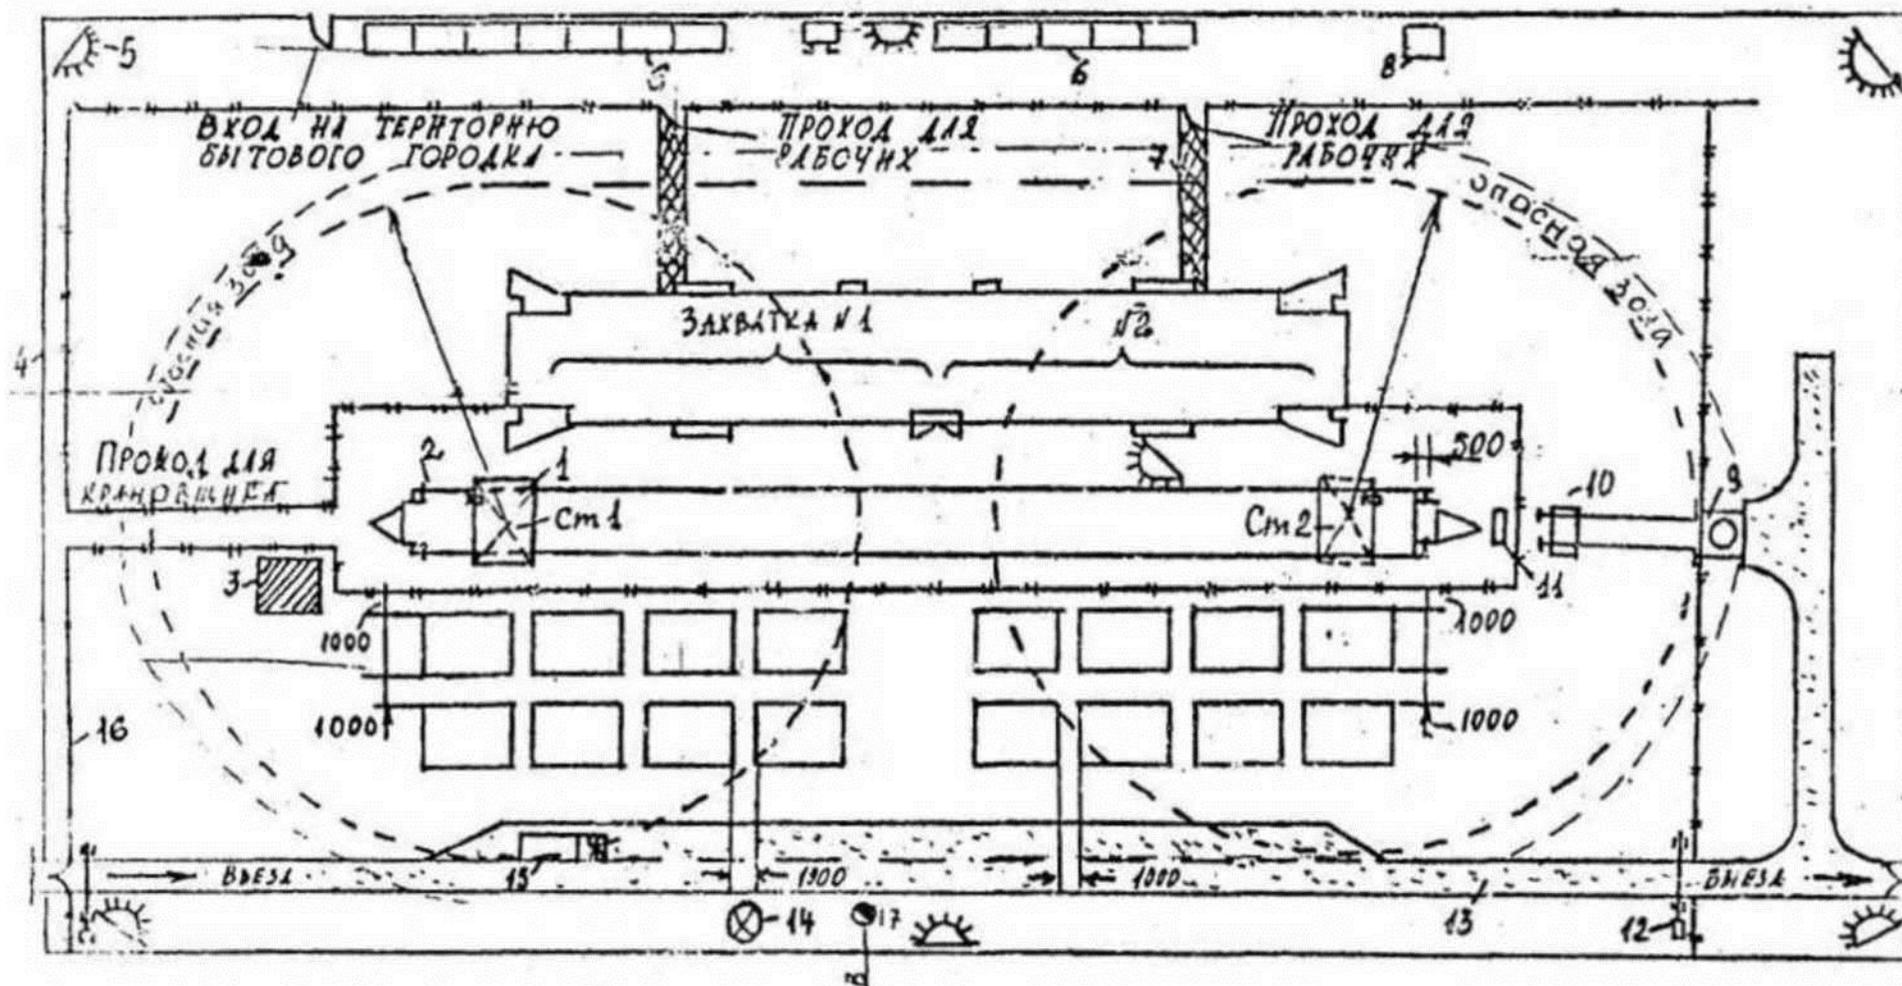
Безопасная организация строительной площадки при возведении надземной части здания:
